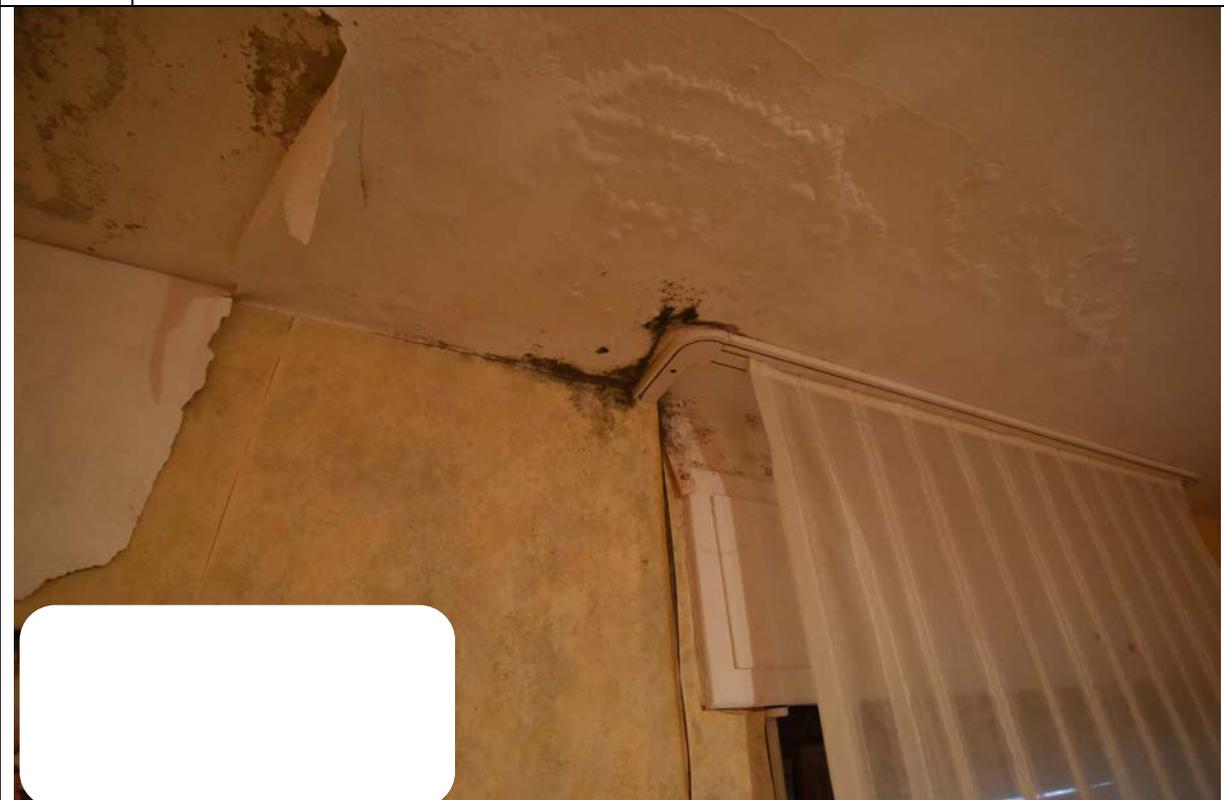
Wohnraum im Dachgeschoss mit erheblichem Feuchtigkeits- und Schimmelbefall
